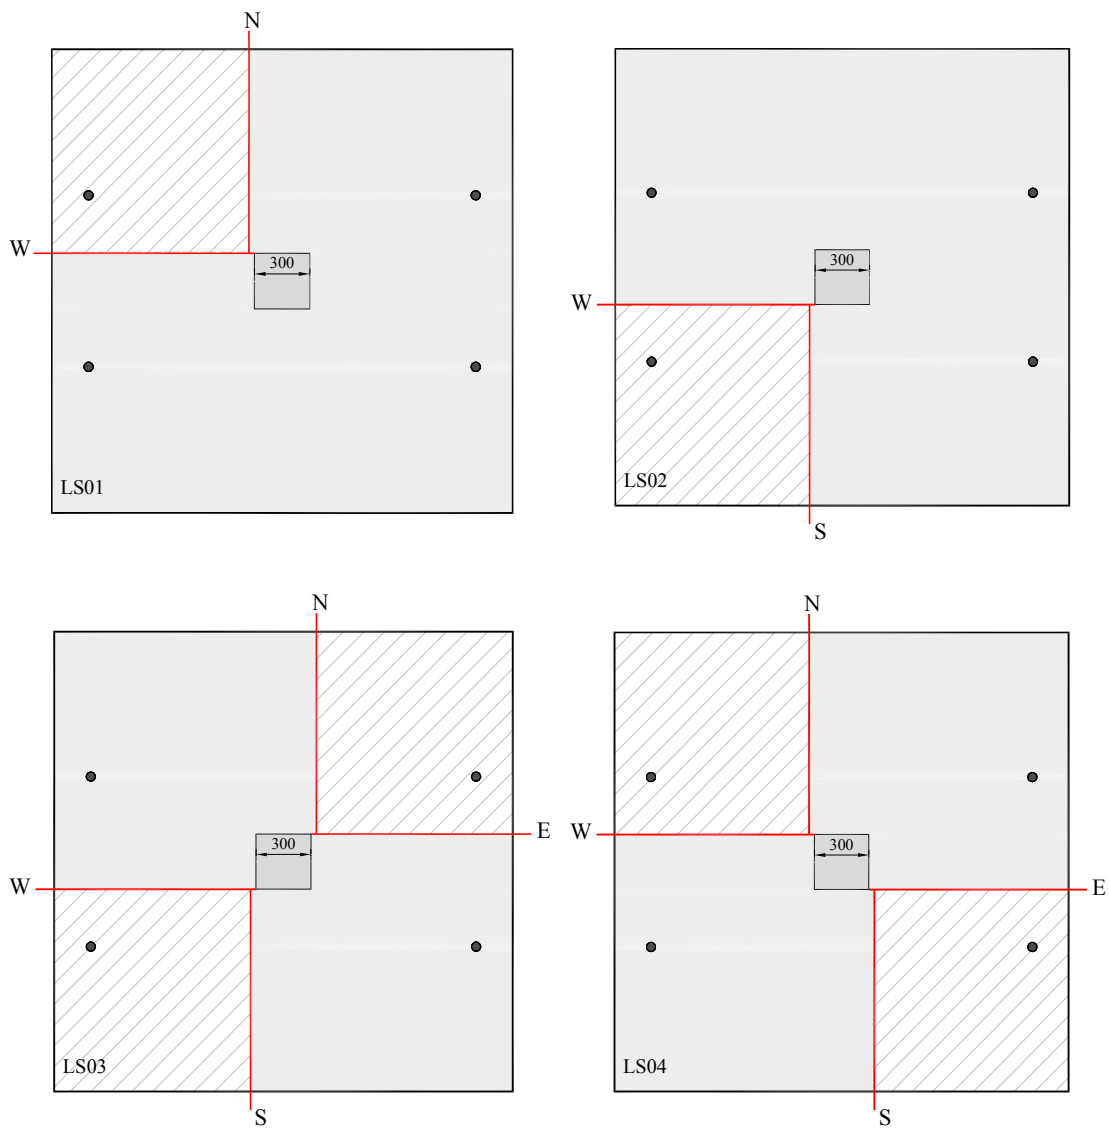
Plano de corte das lajes LS01 à LS04
